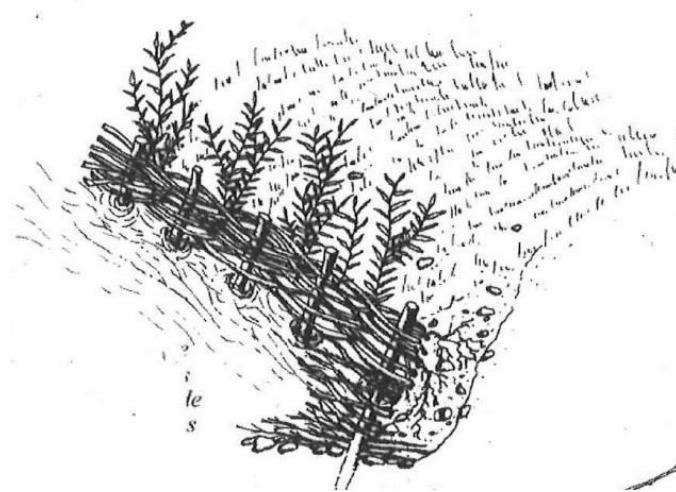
Trenzado vivo. Fuente: www.naturalea.eu
